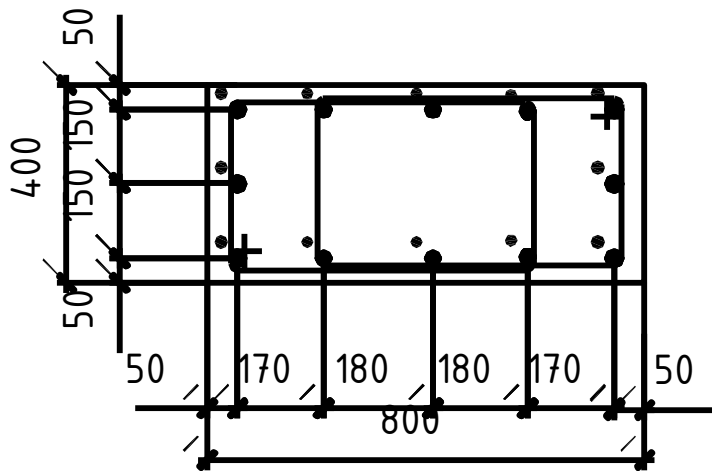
Конструювання поперечного перерізу колони типового поверху
